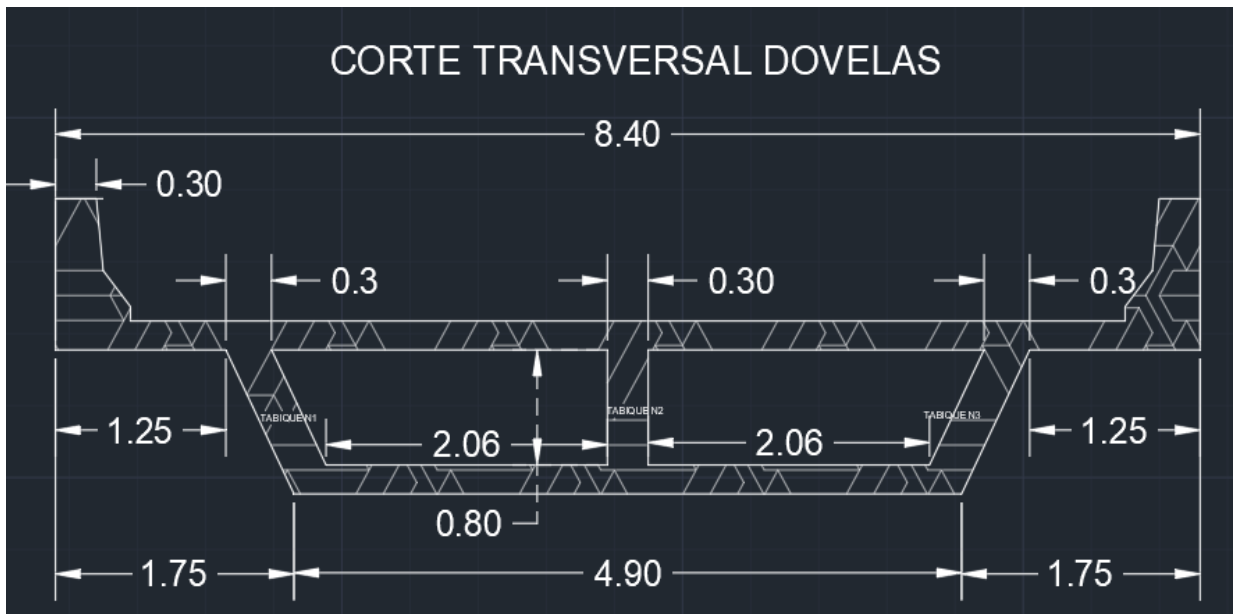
Gráfica de las dovelas prefabricadas utilizadas para la construcción de las líneas del metro de Monterrey.
